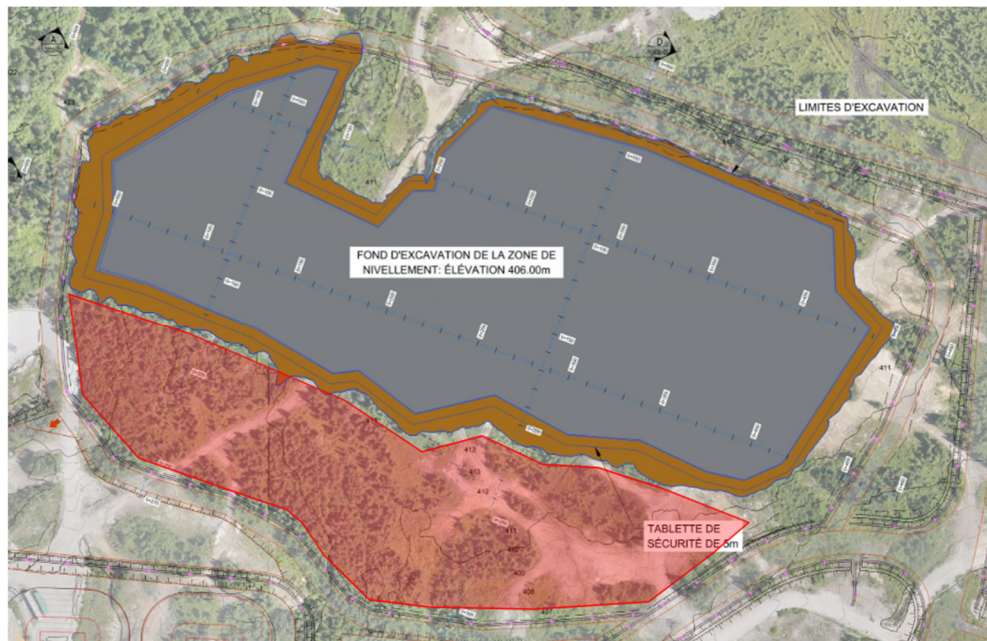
Aperçu de la halde à mort-terrain avec la première zone de remblai (rouge) et la zone nécessitant le nivellement des fondations (grise)
